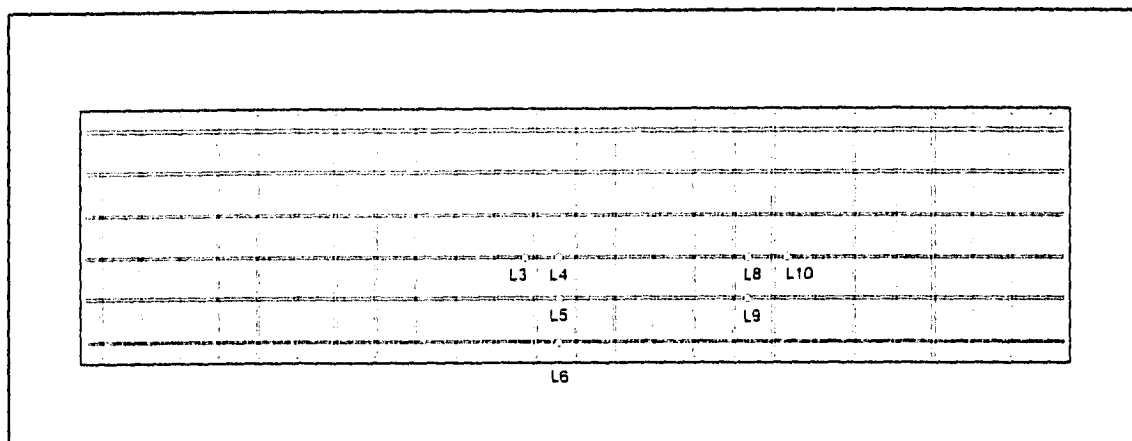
Localización de los Deformímetros en el Refuerzo de la Losa
